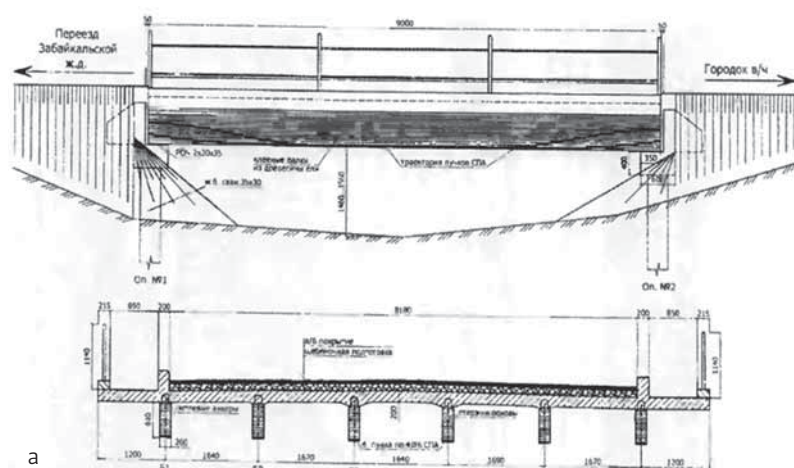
Конструкция деревожелезобетонного пролетного строения с балками из клееной древесины, предварительно напряженной стеклопластиковой арматурой:
